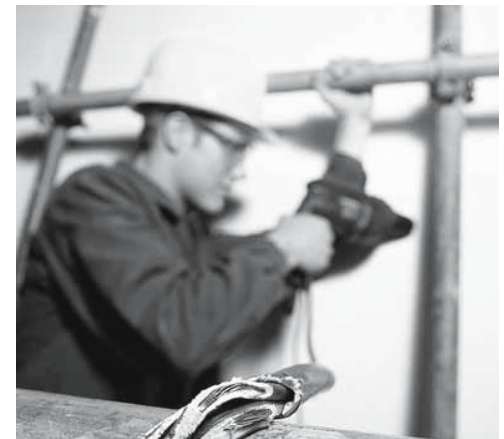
Stecker, Kabel und Elektrohandwerkzeuge vor Gebrauch auf Schäden kontrollieren.
